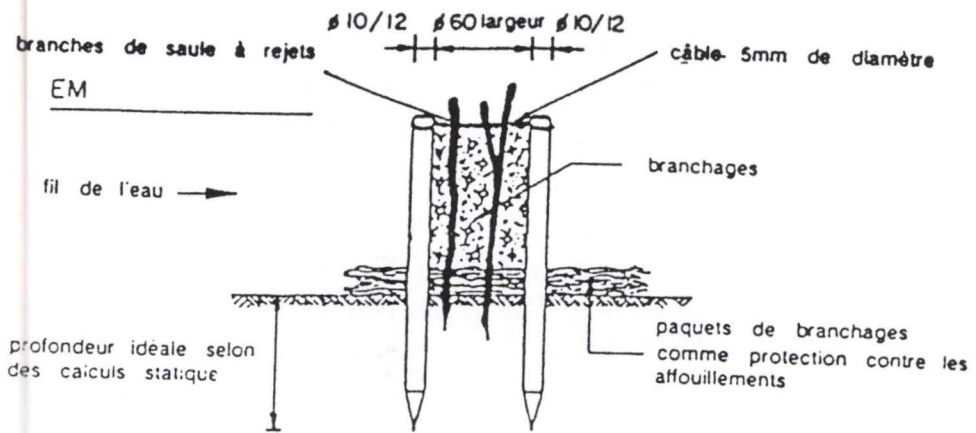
Schéma de la technique de palissade filtrante (d'après Office des ponts et chaussées du Canton de Berne, 1990)
